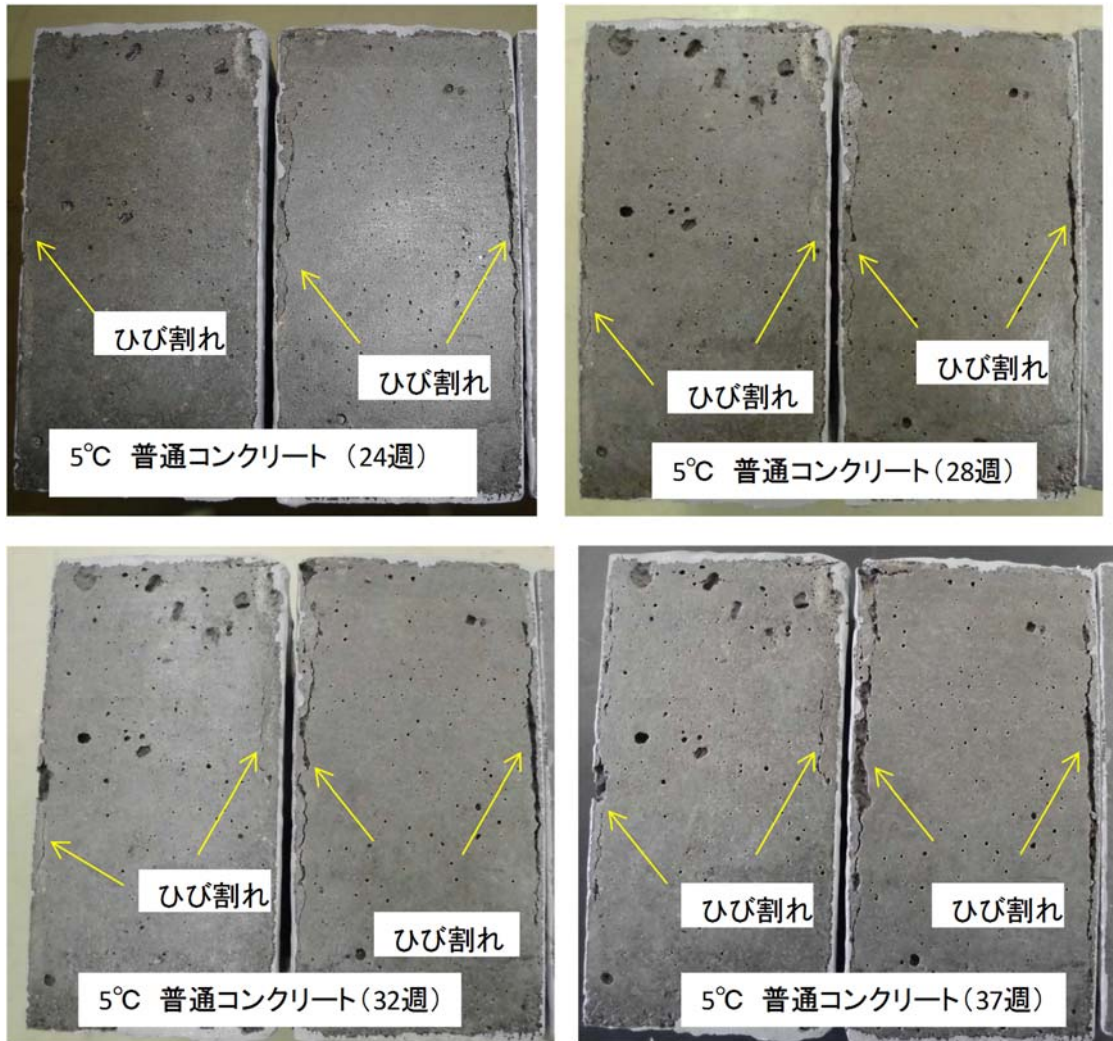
普通コンクリート (5°C) のひび割れの発生状況 (24~37 週)
